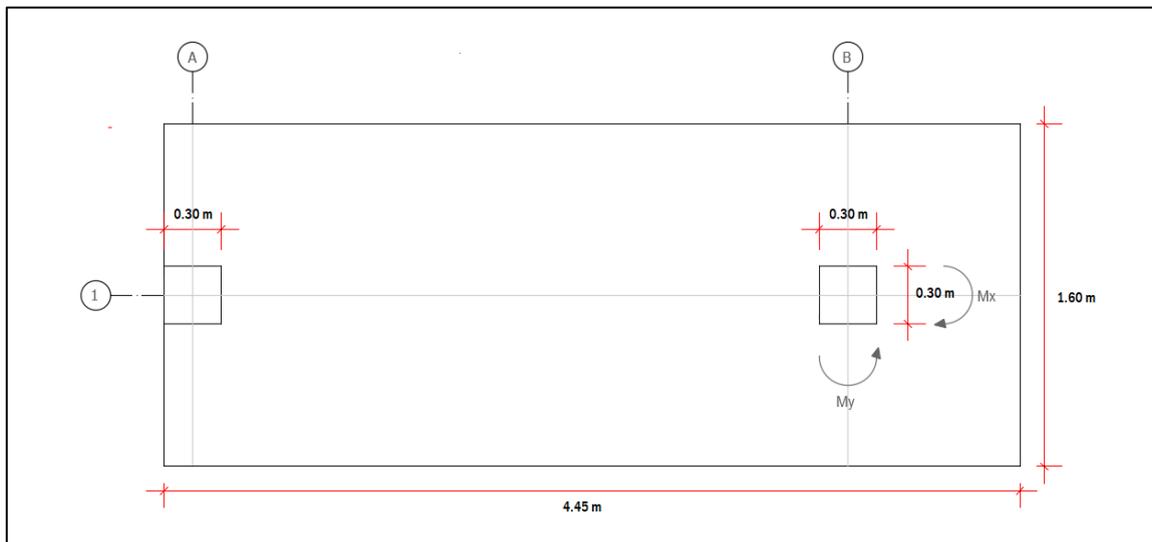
Vista en planta de zapata combinada de edificación de 3 niveles.
